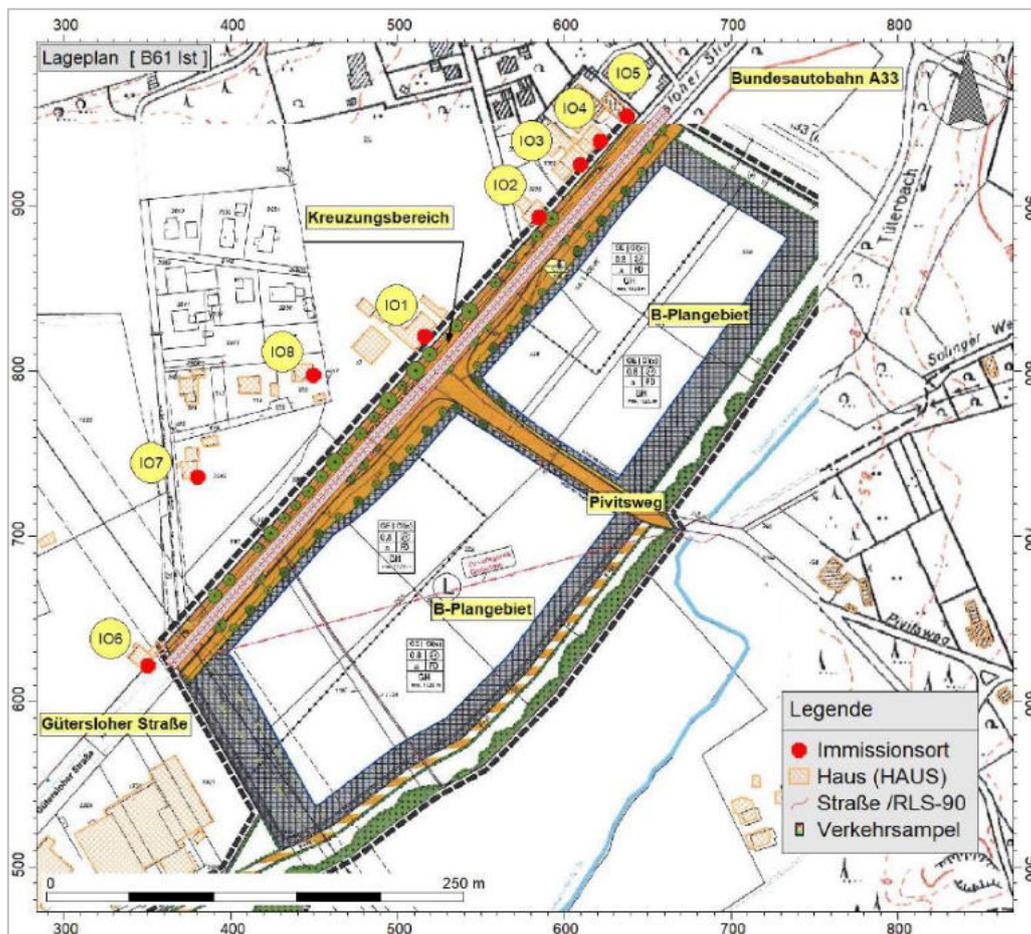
Lage der für die immissionsschutzrechtlichen Berechnungen betrachteten Wohnlagen (Immissionsorte) (DEKRA 2021b)
